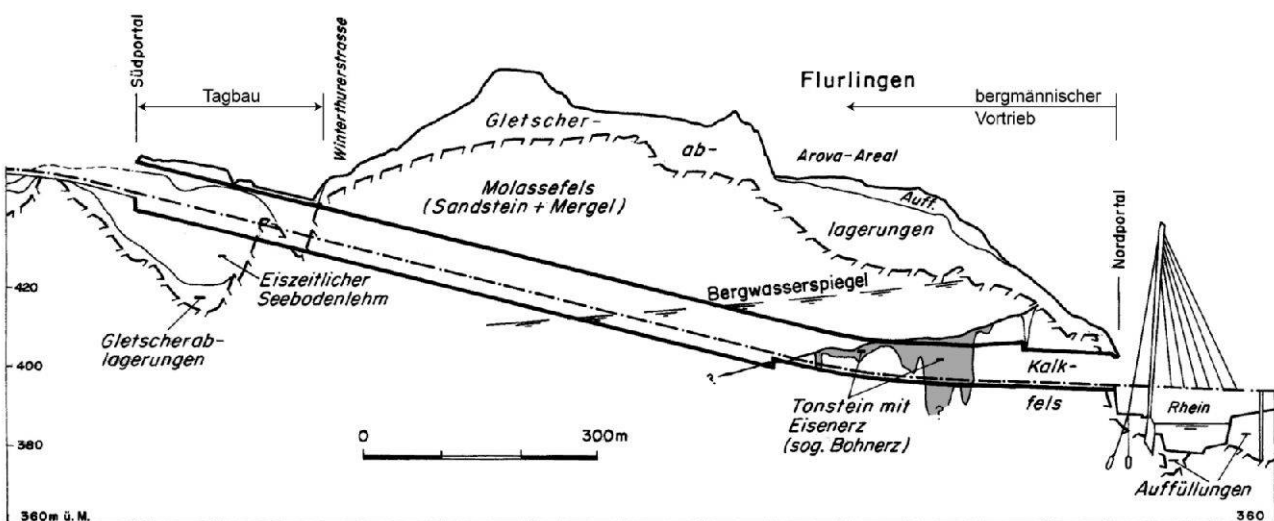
Geologisches Befundprofil N4 Cholfirststunnel, Flurlingen ZH, 5-fach überhöht.
